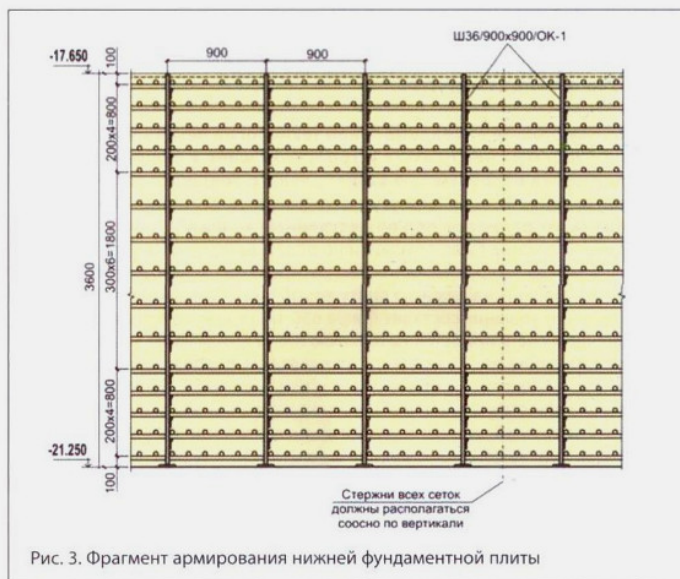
Фрагмент армирования нижней фундаментной плиты
